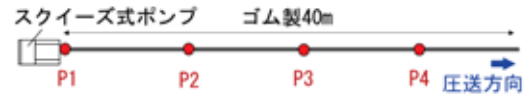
既往①の配管の概要(平面図, 圧送距離40mの例)
